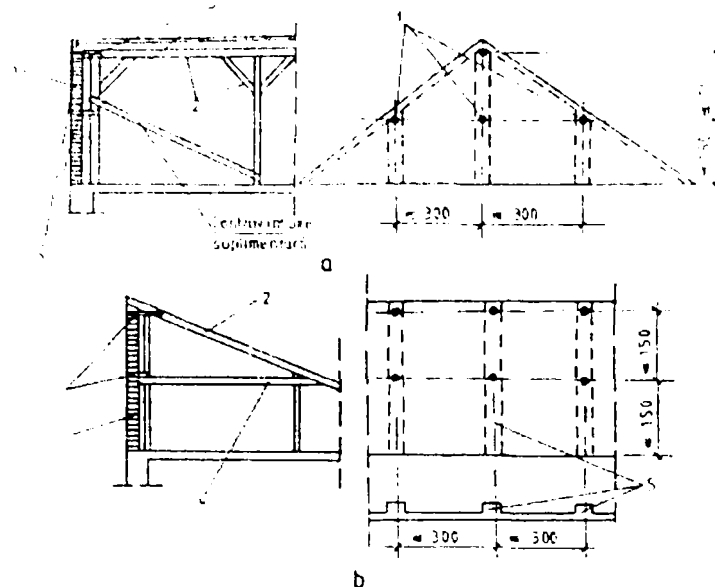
6. Poziția ancorajelor peretelui de calcan față de șarpantă:
